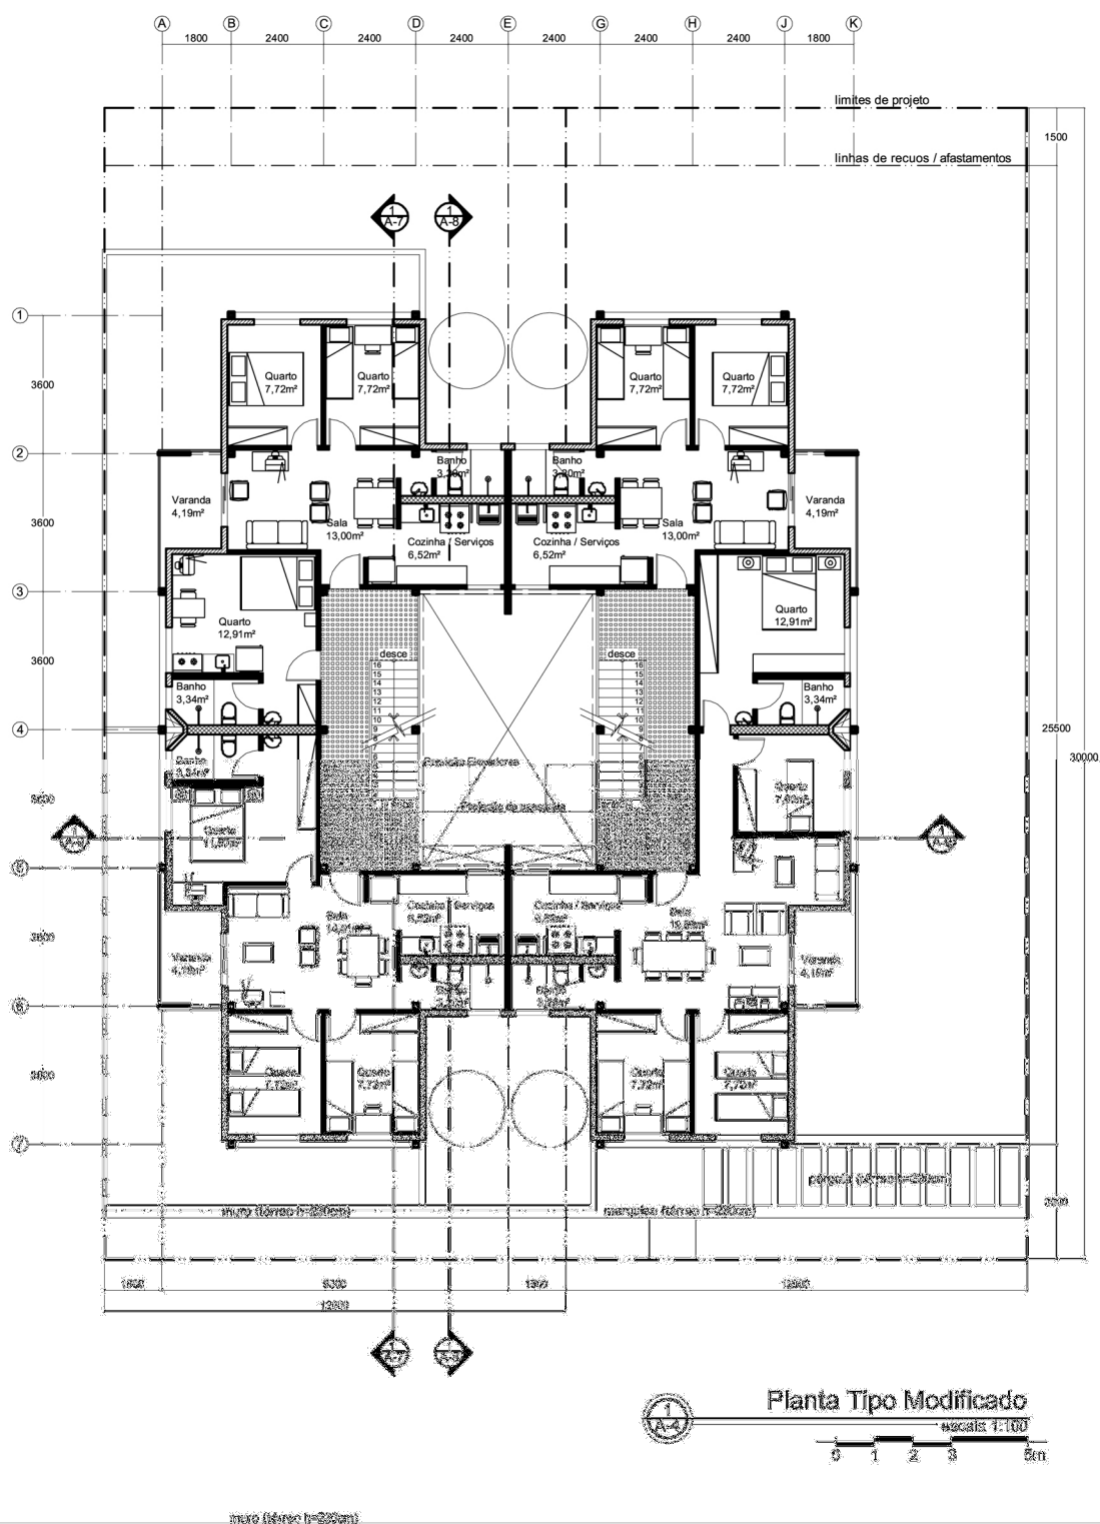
Planta pavimento tipo modificado. Fonte: Arquivo do autor
